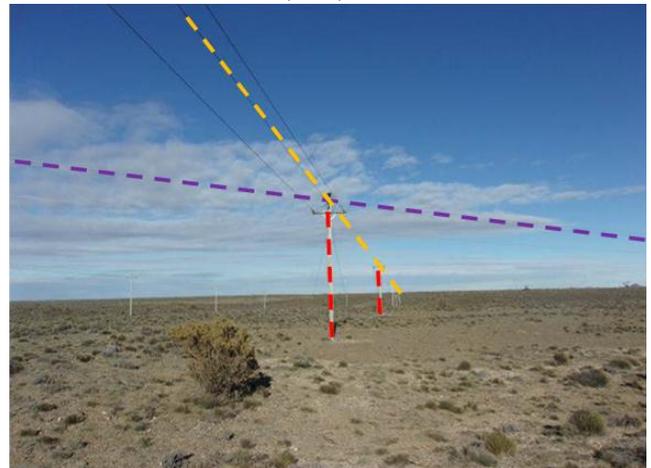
Fotografía III.C-106. Línea eléctrica (naranja) por detrás del alambrado rural (azul). Foto en dirección SO.
